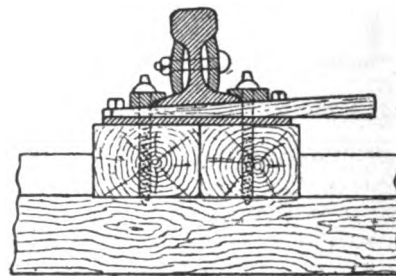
e 24. — Giunto Rambacher per armamenti più leggeri. - Vista e sezione.
